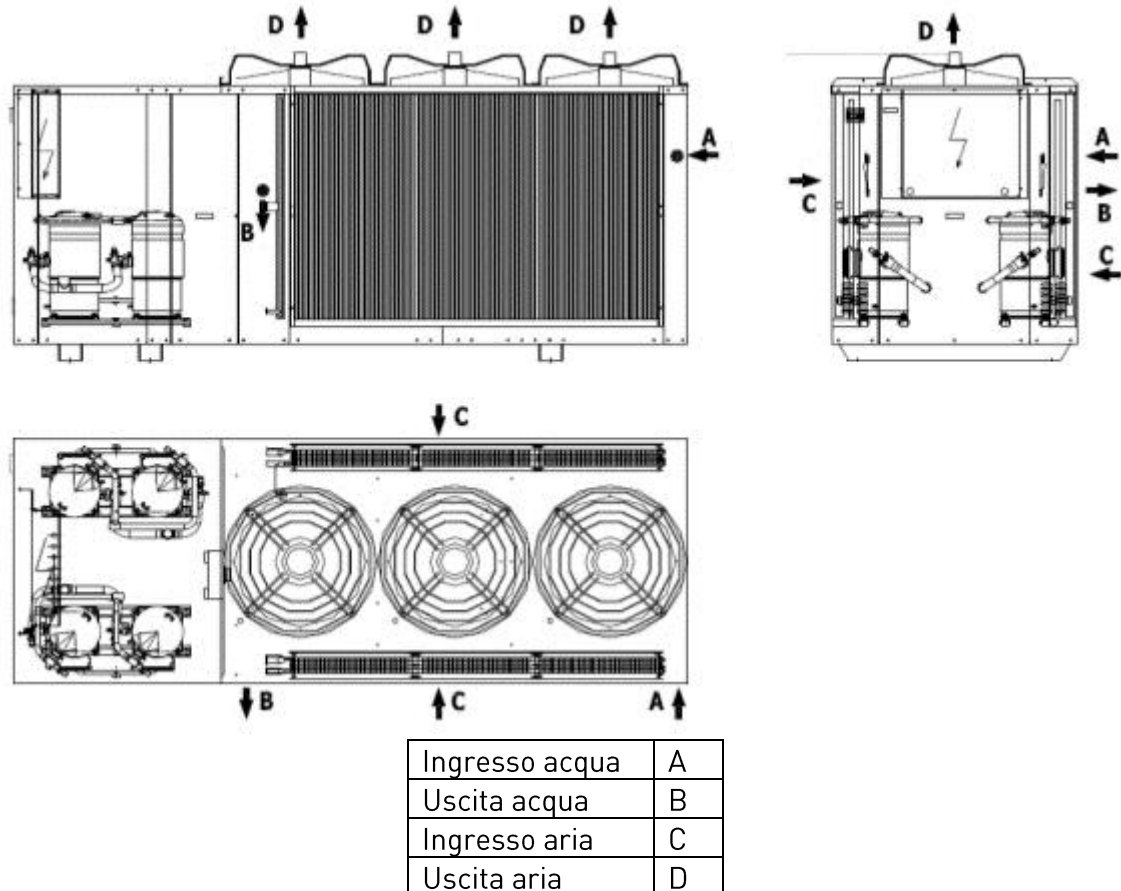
Disegni tecnici del frigorifero installato nella Serra
